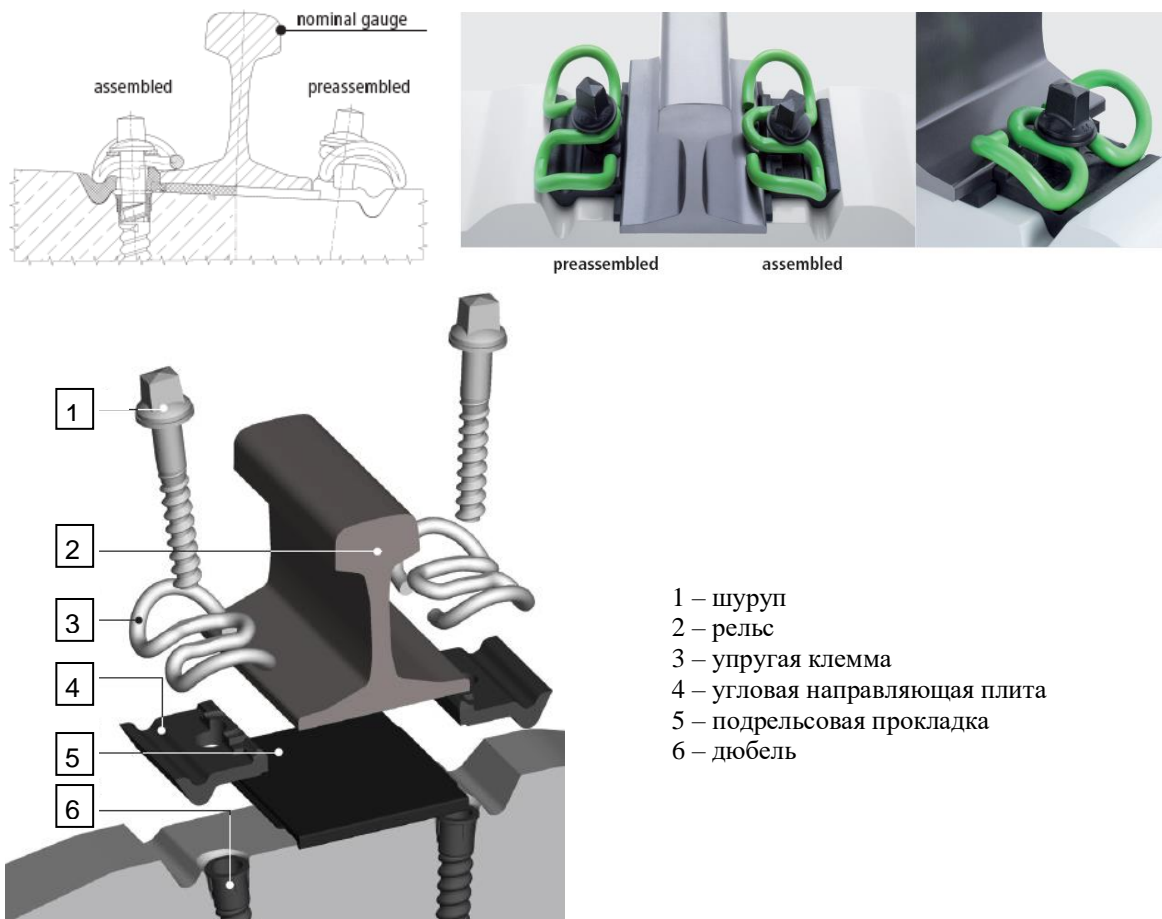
Железобетонная шпала со специально оформленными для крепления подрельсовыми площадками – оформленные желоба и забетонированные дюбели для креплений Vossloh
